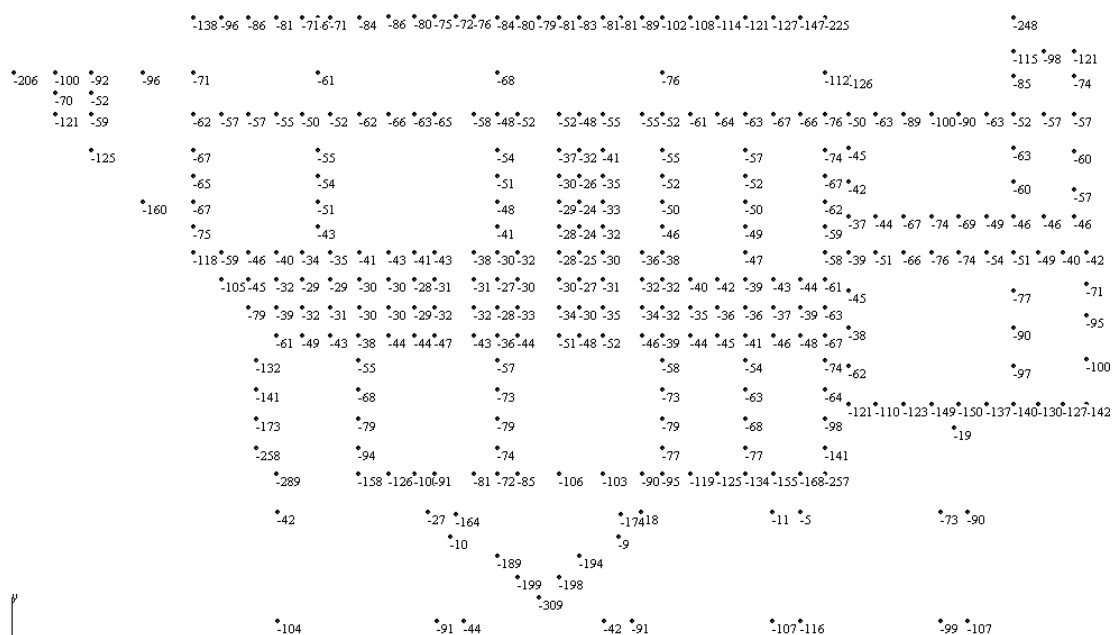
Нагрузки на сваи (тс) в области примыкания 20-этажного здания
